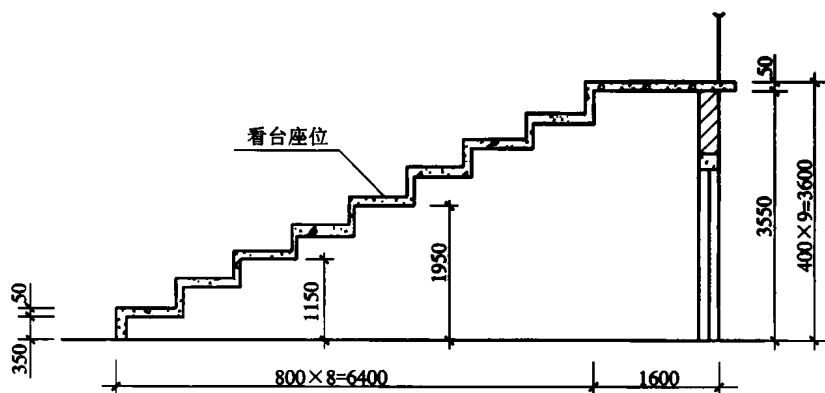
看台下空间(场馆看台剖面图)计算建筑面积示意图
